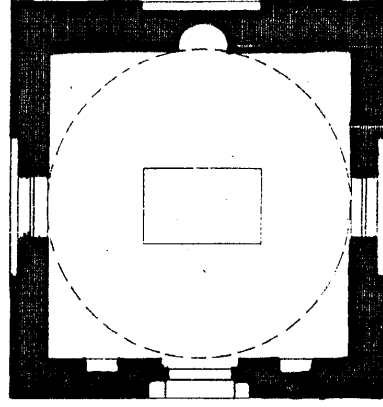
مسقط أفقي لقبة الأمير جاويش
